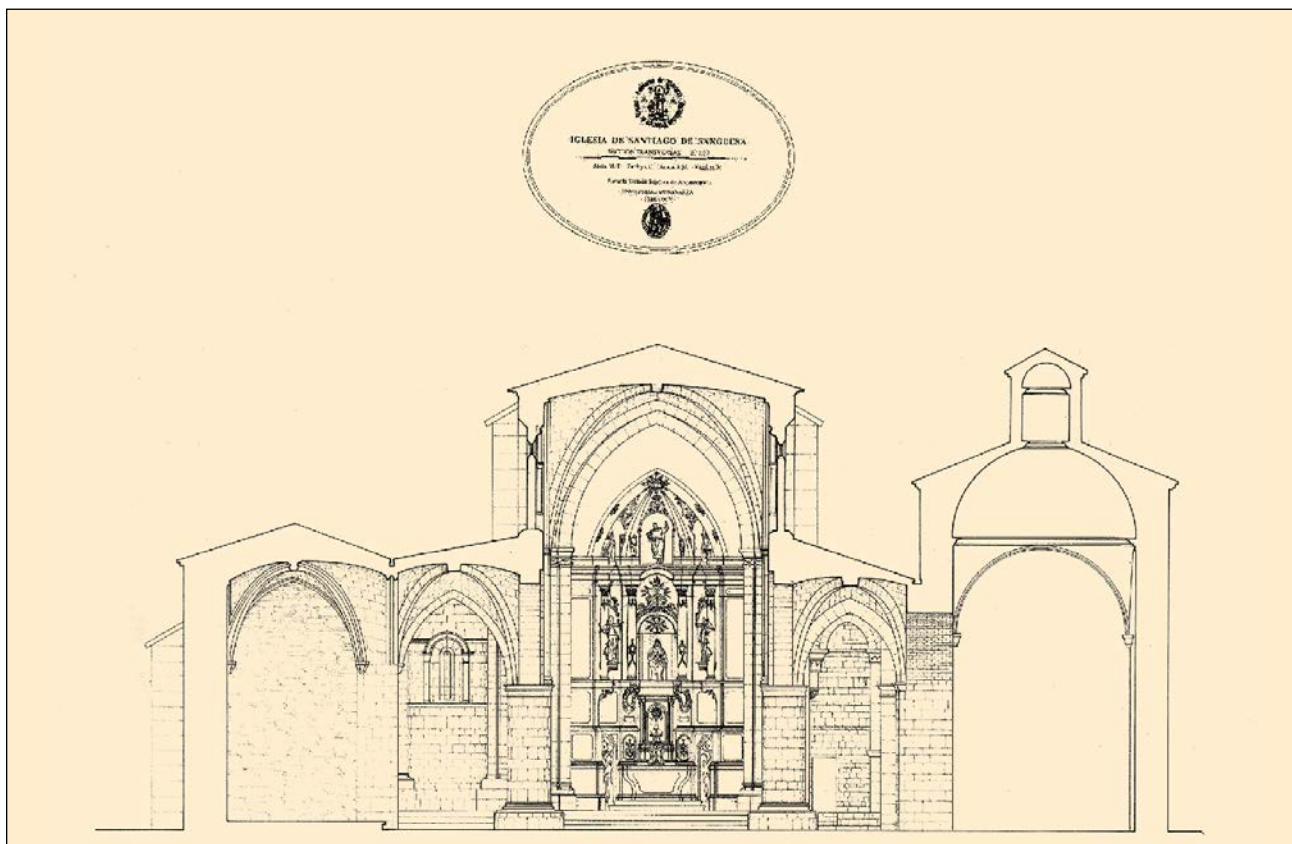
Sangüesa, Santiago, alzado interior cabecera
